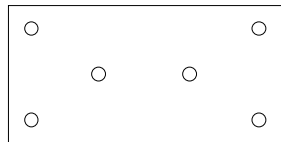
Plans de chevillage - panneaux de dimensions 1000 × 500 mm
